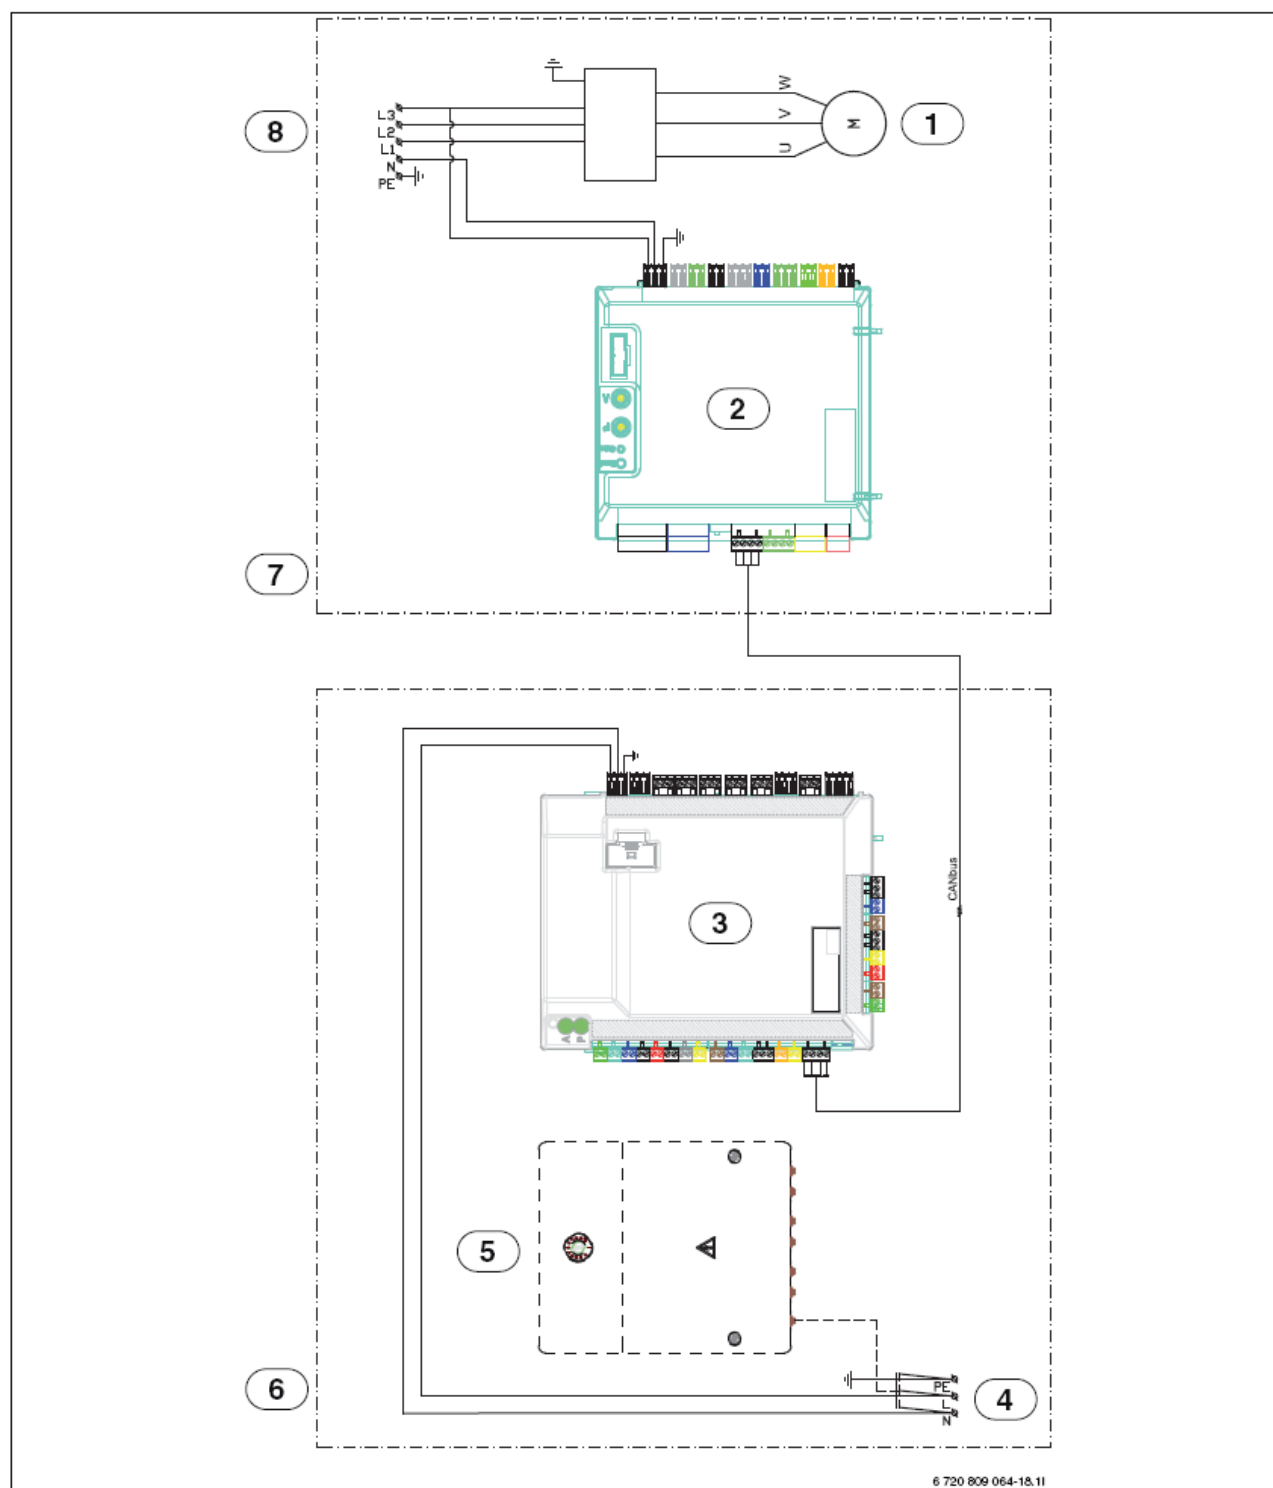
Внутренний блок с внешним дополнительным нагревателем – Обзор
